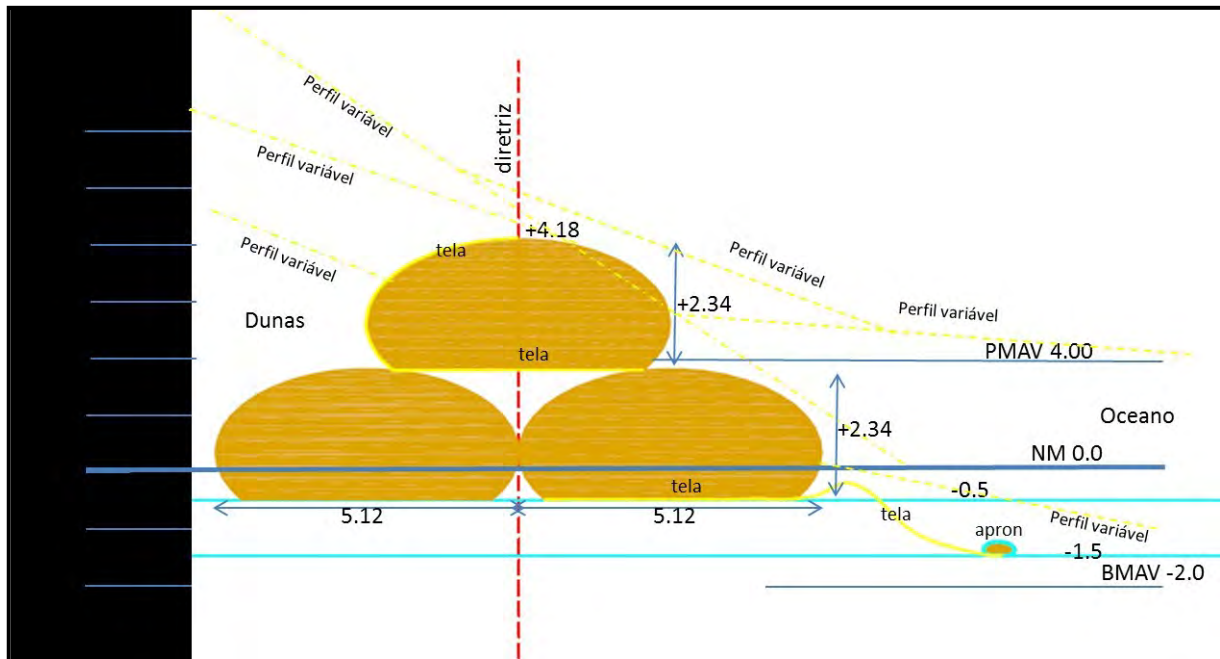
Representação da secção transversal tipo. Seções transversais apresentadas em ficheiro próprio.
